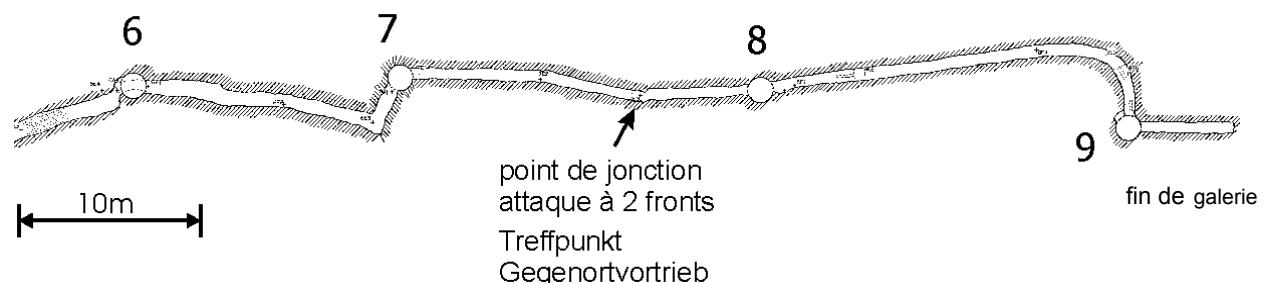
plan de situation 6-7-8-9 avec une erreur d'implantation du gisement horizontal au puits 9 et avec point de rencontre entre les puits 7 et 8 de l'avancée simultanée à partir de ces puits.
